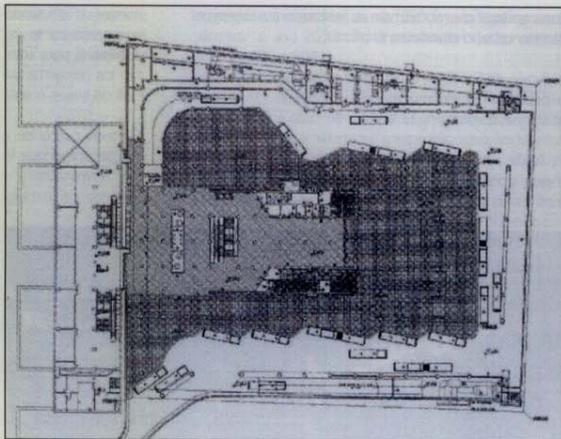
Planta del primer subterráneo de la EIM La Cisterna
